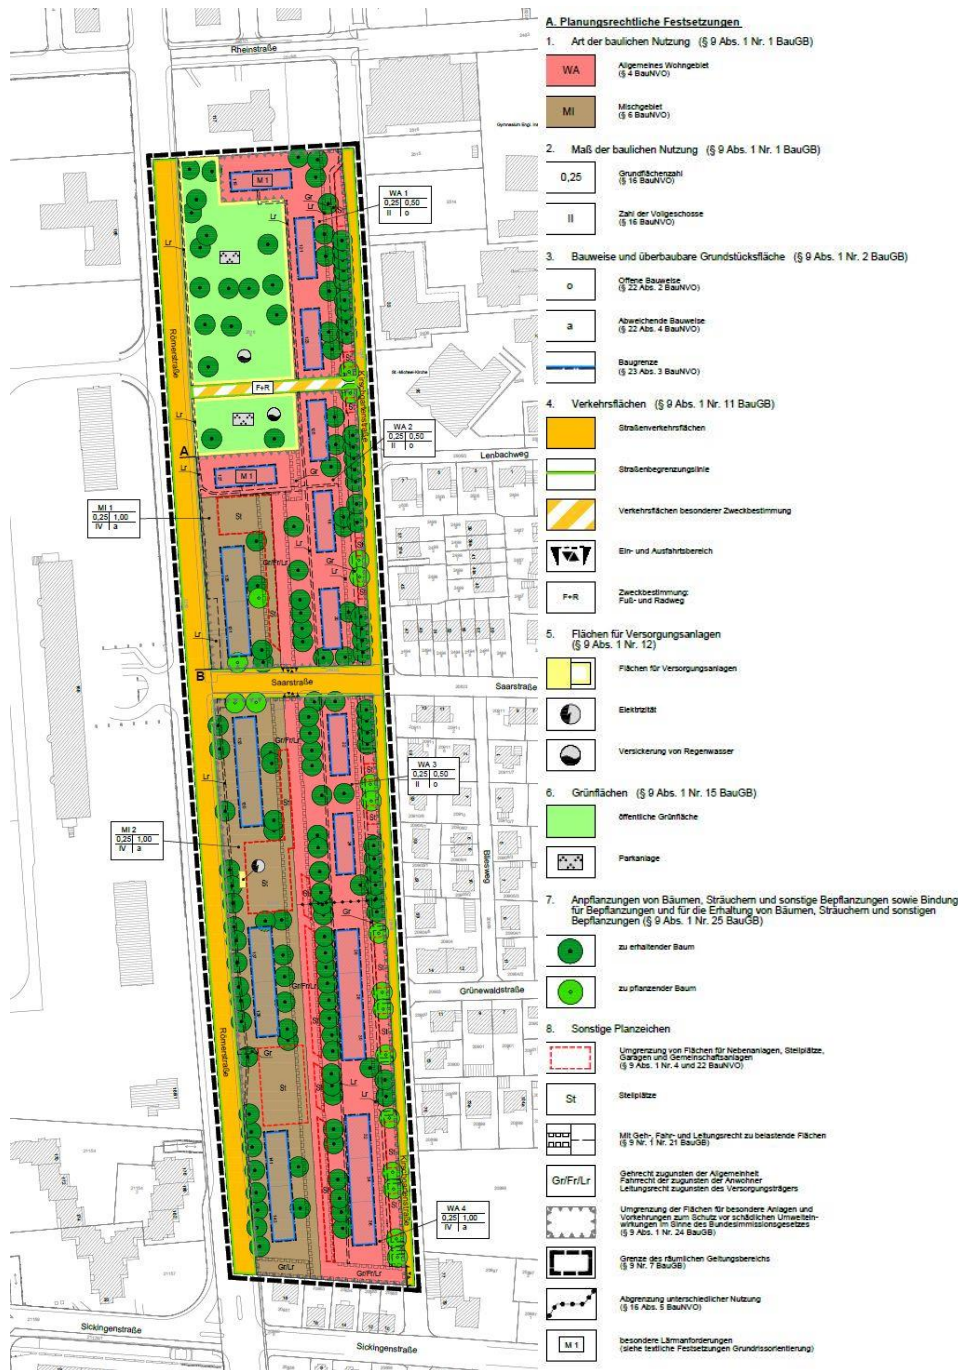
Städtebauliche Planungskonzeption erster Teil-Bebauungsplan
